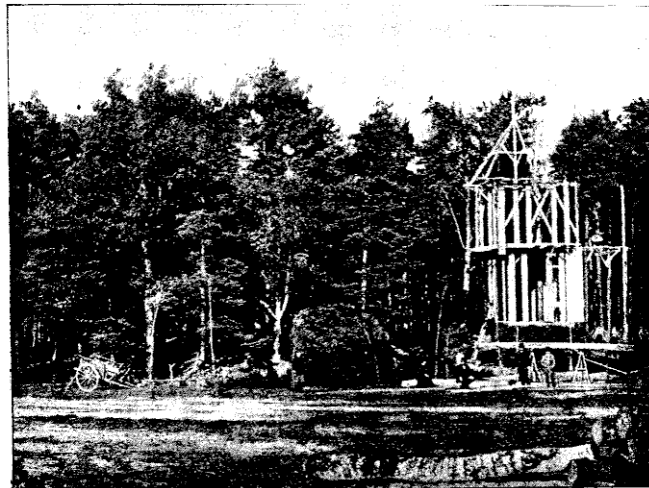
Construction en planches du modèle du Pavillon en grandeur d'exécution. (Carrefour de la Croix-de-Toulouse dans la forêt de Fontainebleau.)
